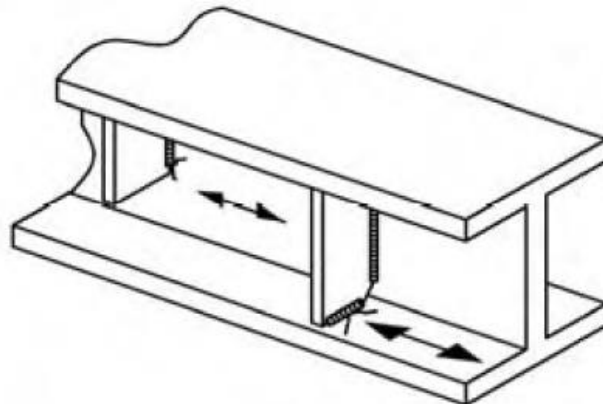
Fisura que inicia al final de la soldadura en la base del rigidizador transversal hacia el metal base (Categoría C')
